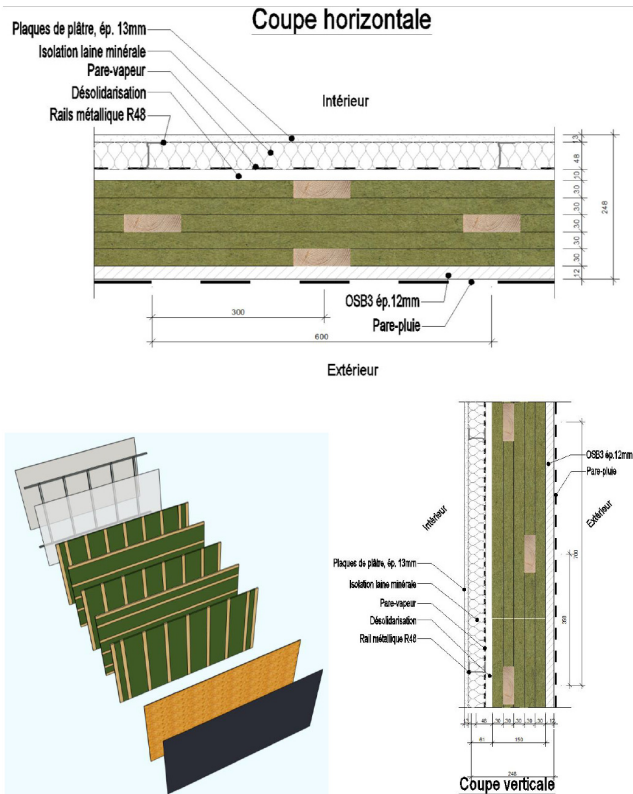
Description d'un exemple de complexe de façade constitué d'un PANOBLOC® 5 plis.
